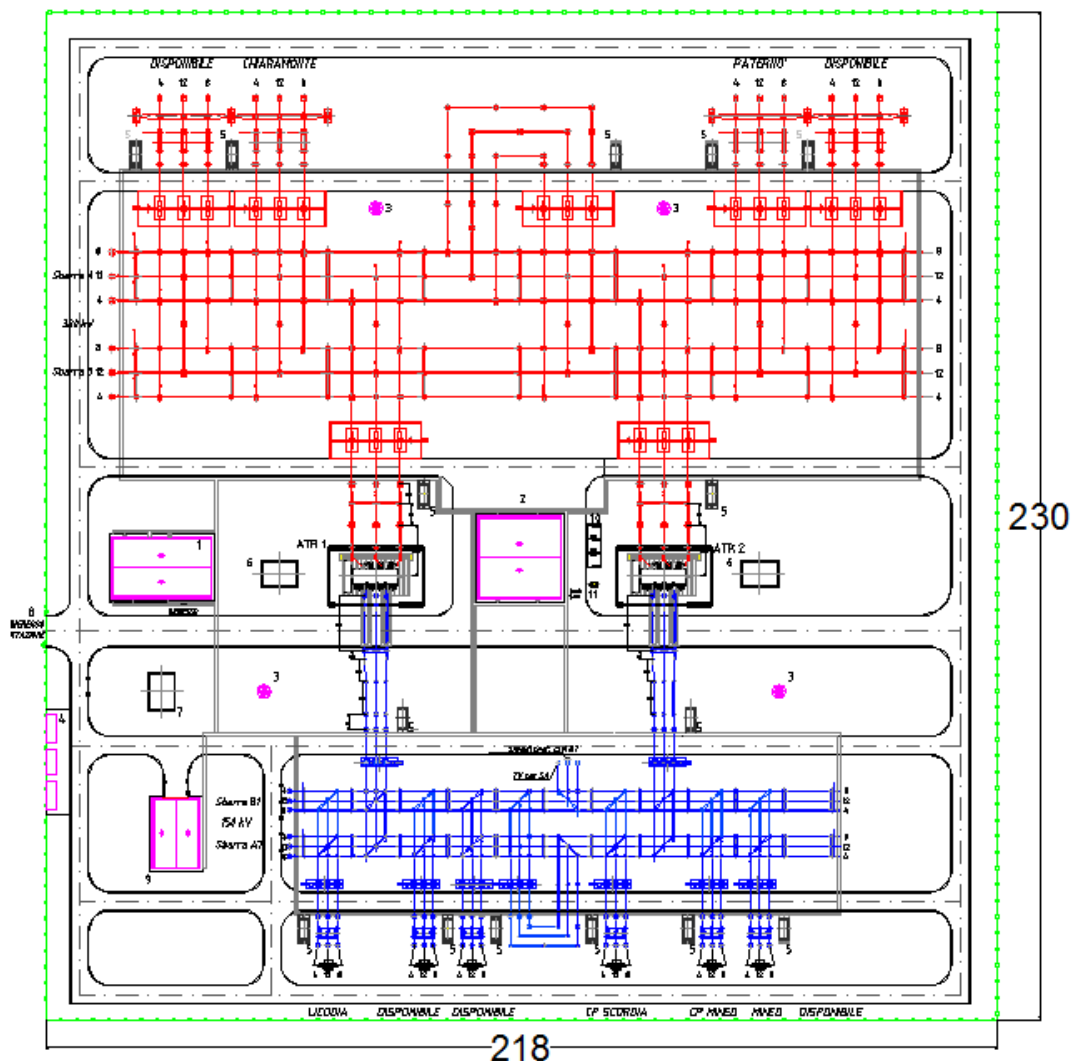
Planimetria generale elettromeccanica della futura SE di Vizzini
